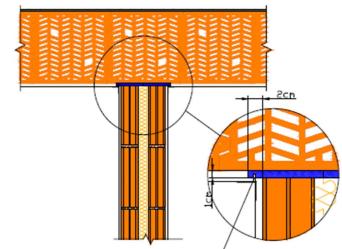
Encuentro tabique de fábrica con fachada en planta
